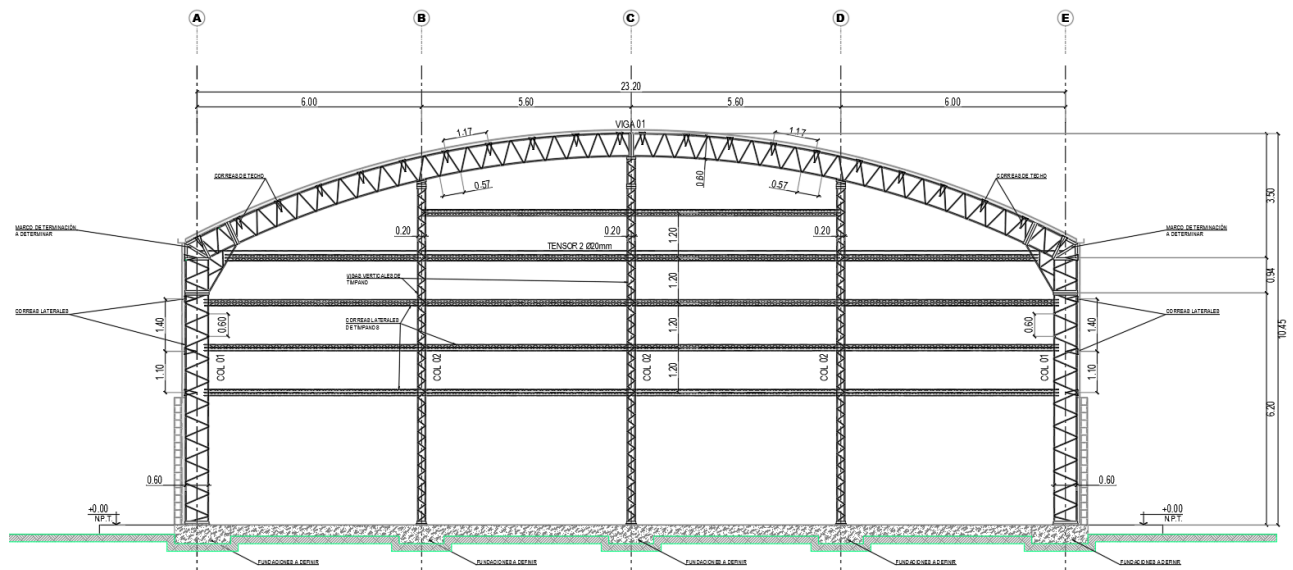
PÓRTICOS | CORTE TRANSVERSAL – EJE 1 Y 6
